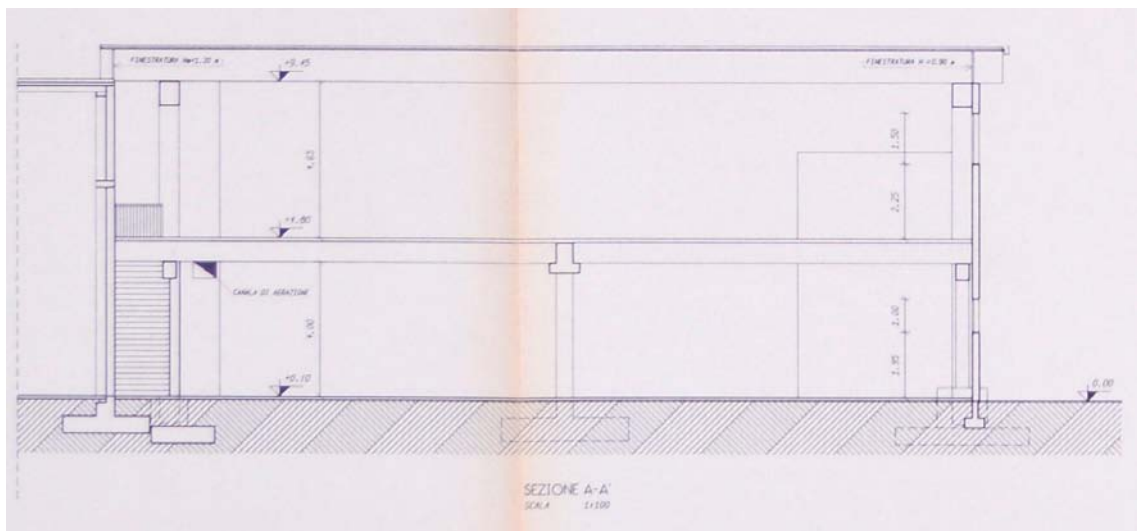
Particolare di A.1996.cap.sa.T03 - Piante prospetti e sezioni - Sezione tipo
